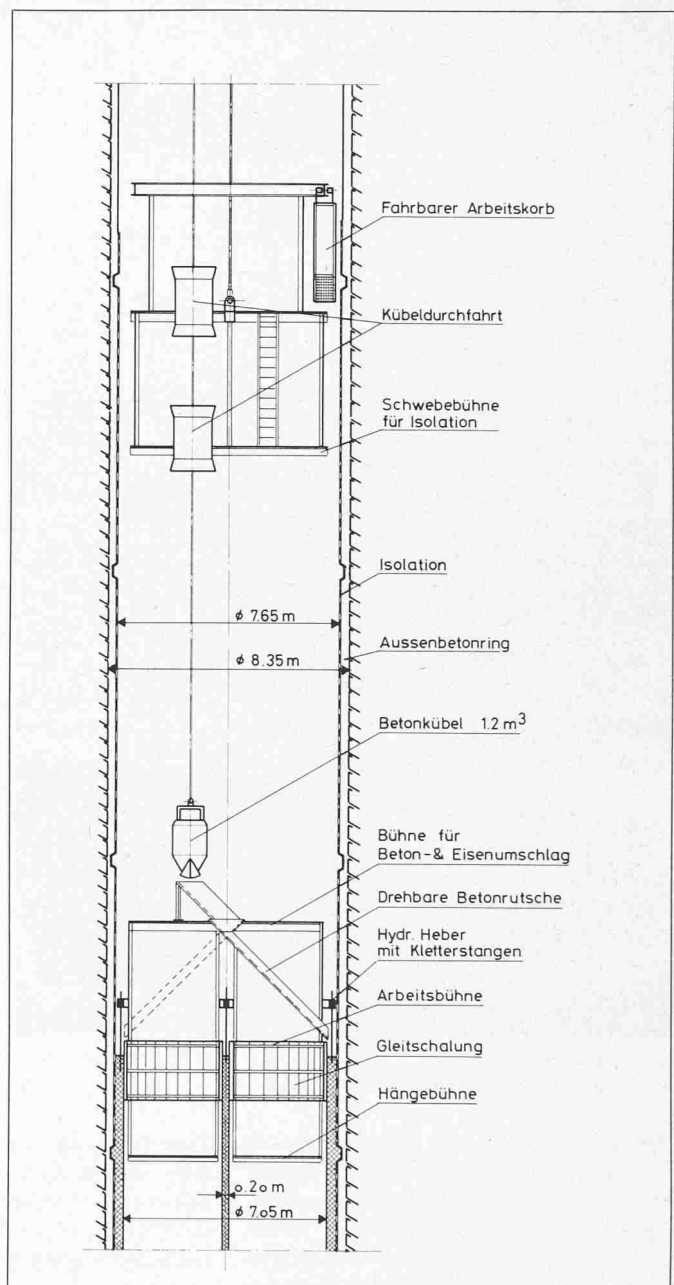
Teillängsschnitt mit Bauinstallation für Isolation, Innenbetonring und Trennwand
